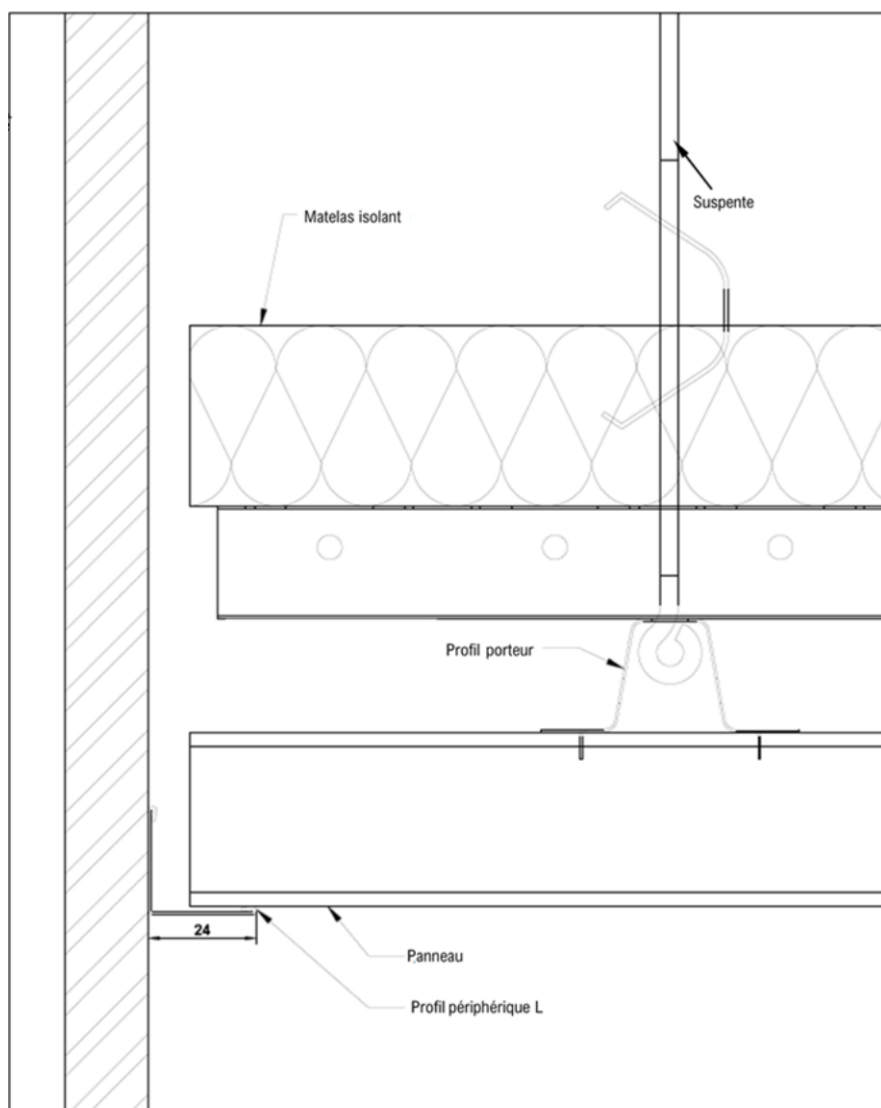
coupe longitudinale du plafond SAPP Ceiling®
